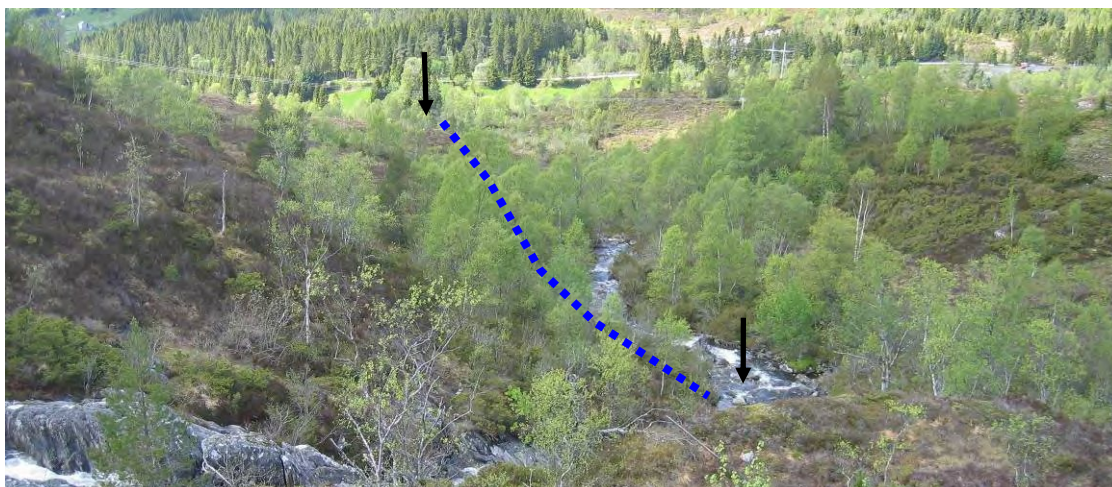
Utløpet av Navevatnet. En lav betongterskel er planlagt etablert om lag langs den stiplede linjen. Videre etableres arrangement for slipping av minstevannsføring.
